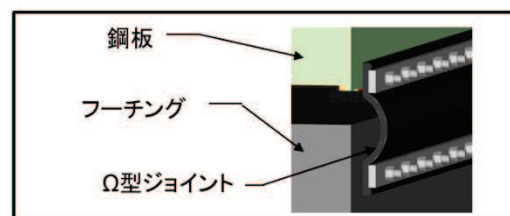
鋼製遮水壁（鋼板）の平面配置図
